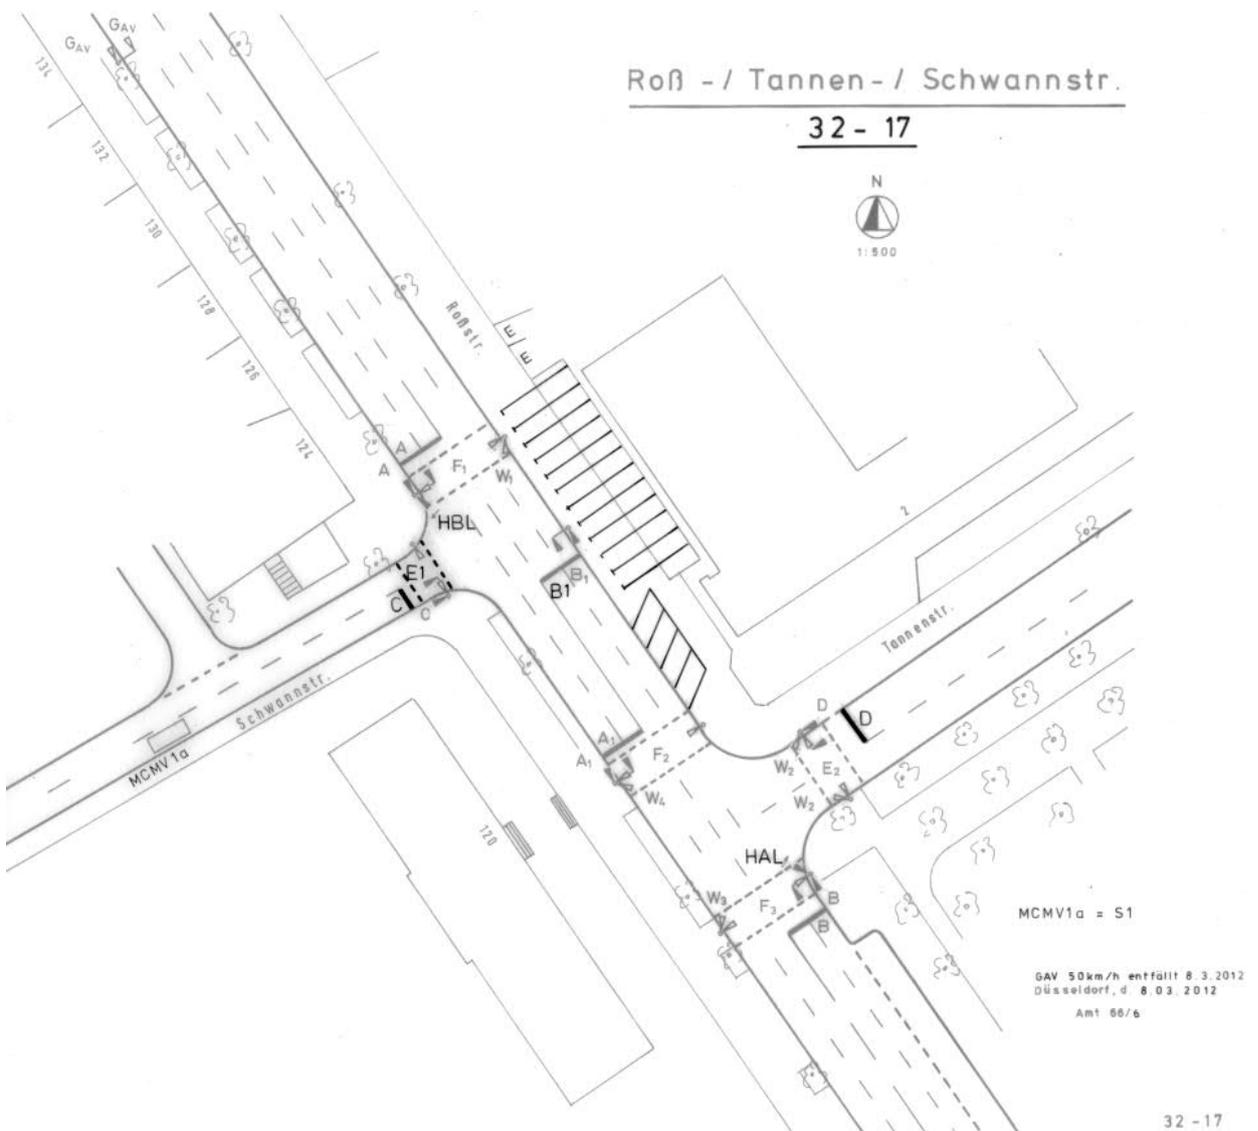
Lageplan Lichtsignalanlage Knoten 32-17 [21]
